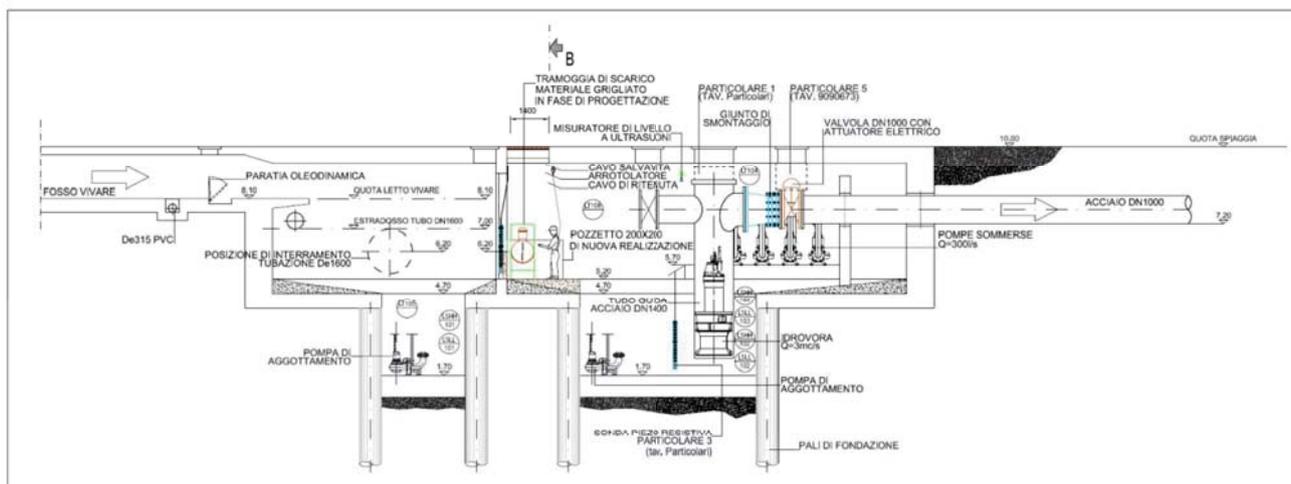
Impianto di sollevamento "Vienna": sezione stato di fatto
